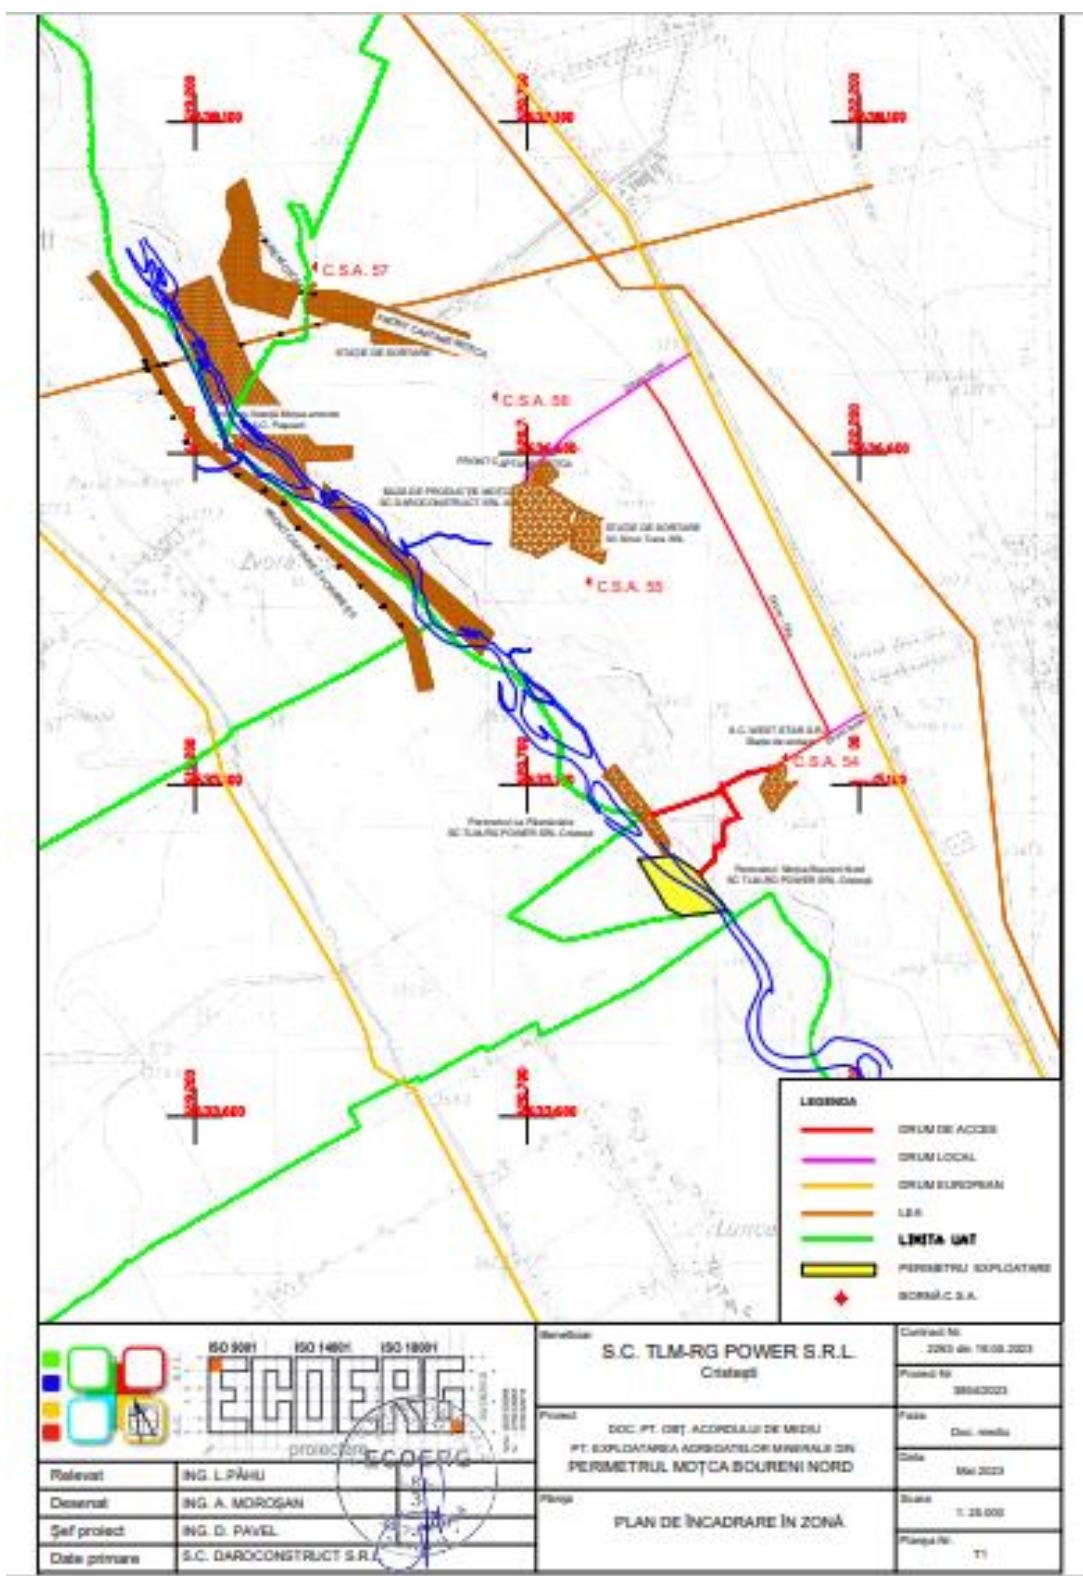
Plan de încadrare în zonă perimetru Moțca Boureni Nord
